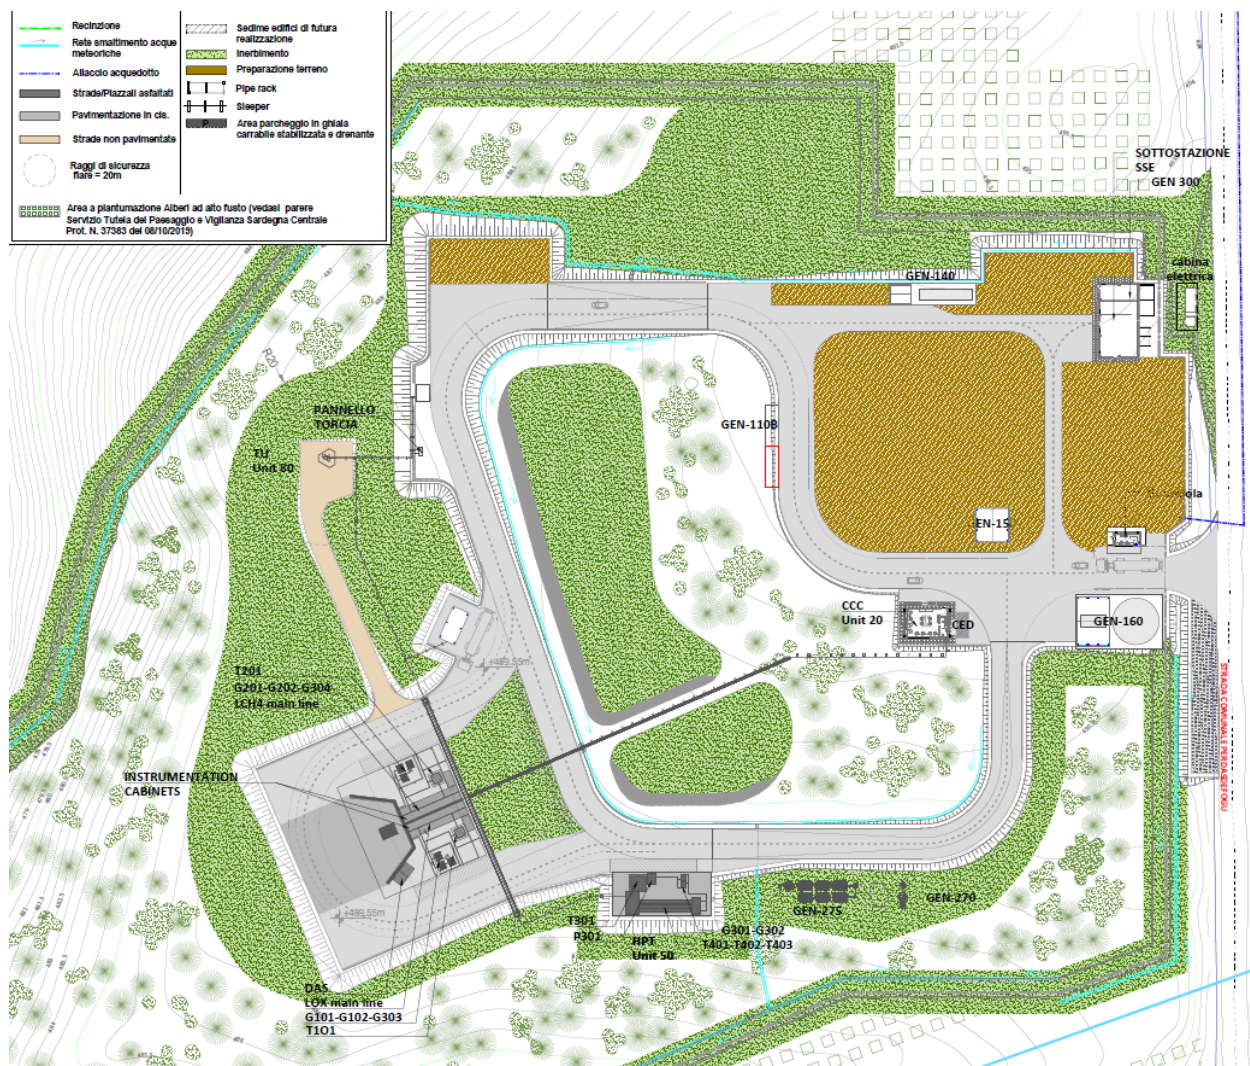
Planimetria generale dell'intero stabilimento SPTF Esistente come realizzato
